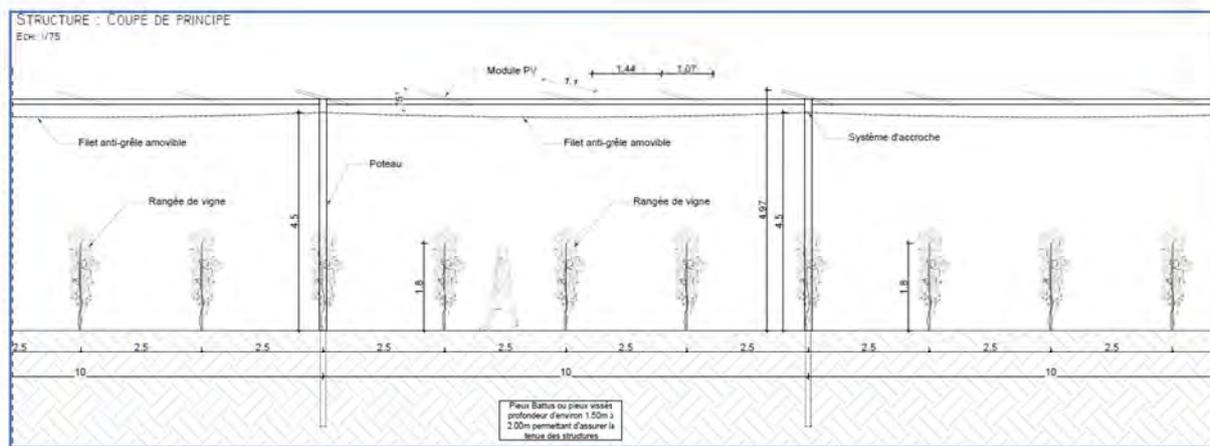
Coupe longitudinale d'un rang de l'installation photovoltaïque (en m)
